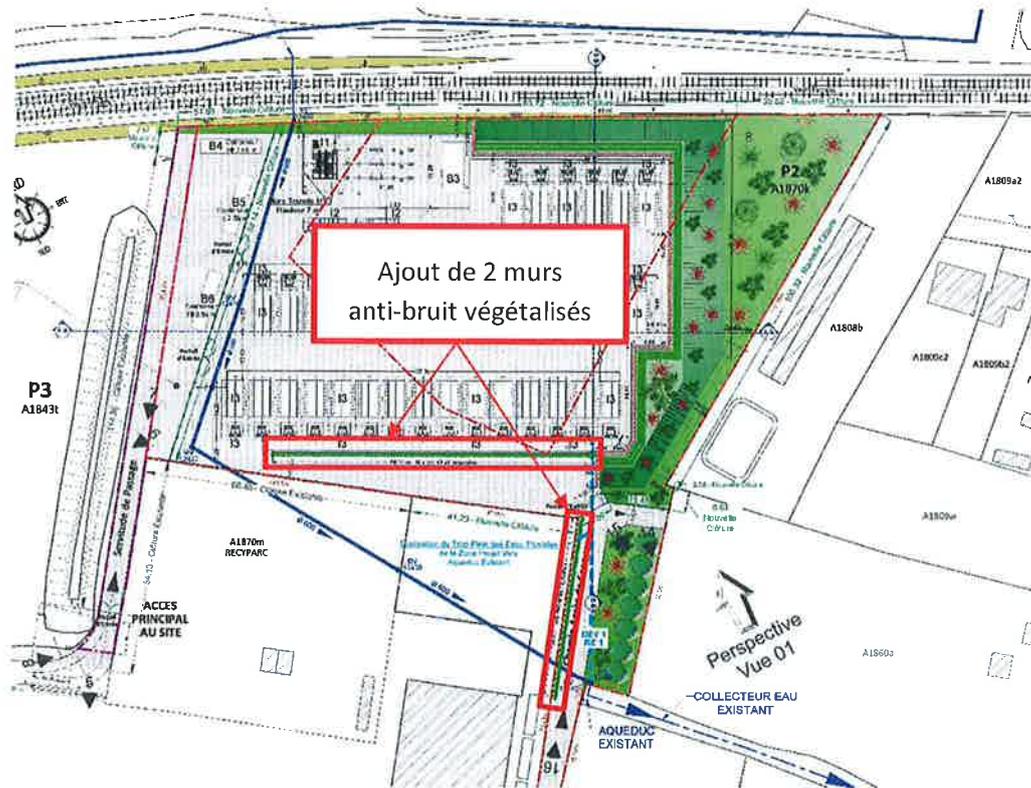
Plans modificatifs (juillet 2024). Vue en plan du projet modifié, ajout de 2 murs anti-bruit.
